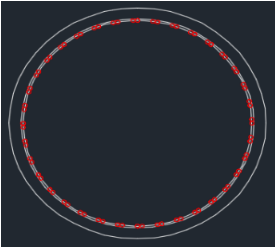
Hoja de cálculo para disposición de armado en pilas.
